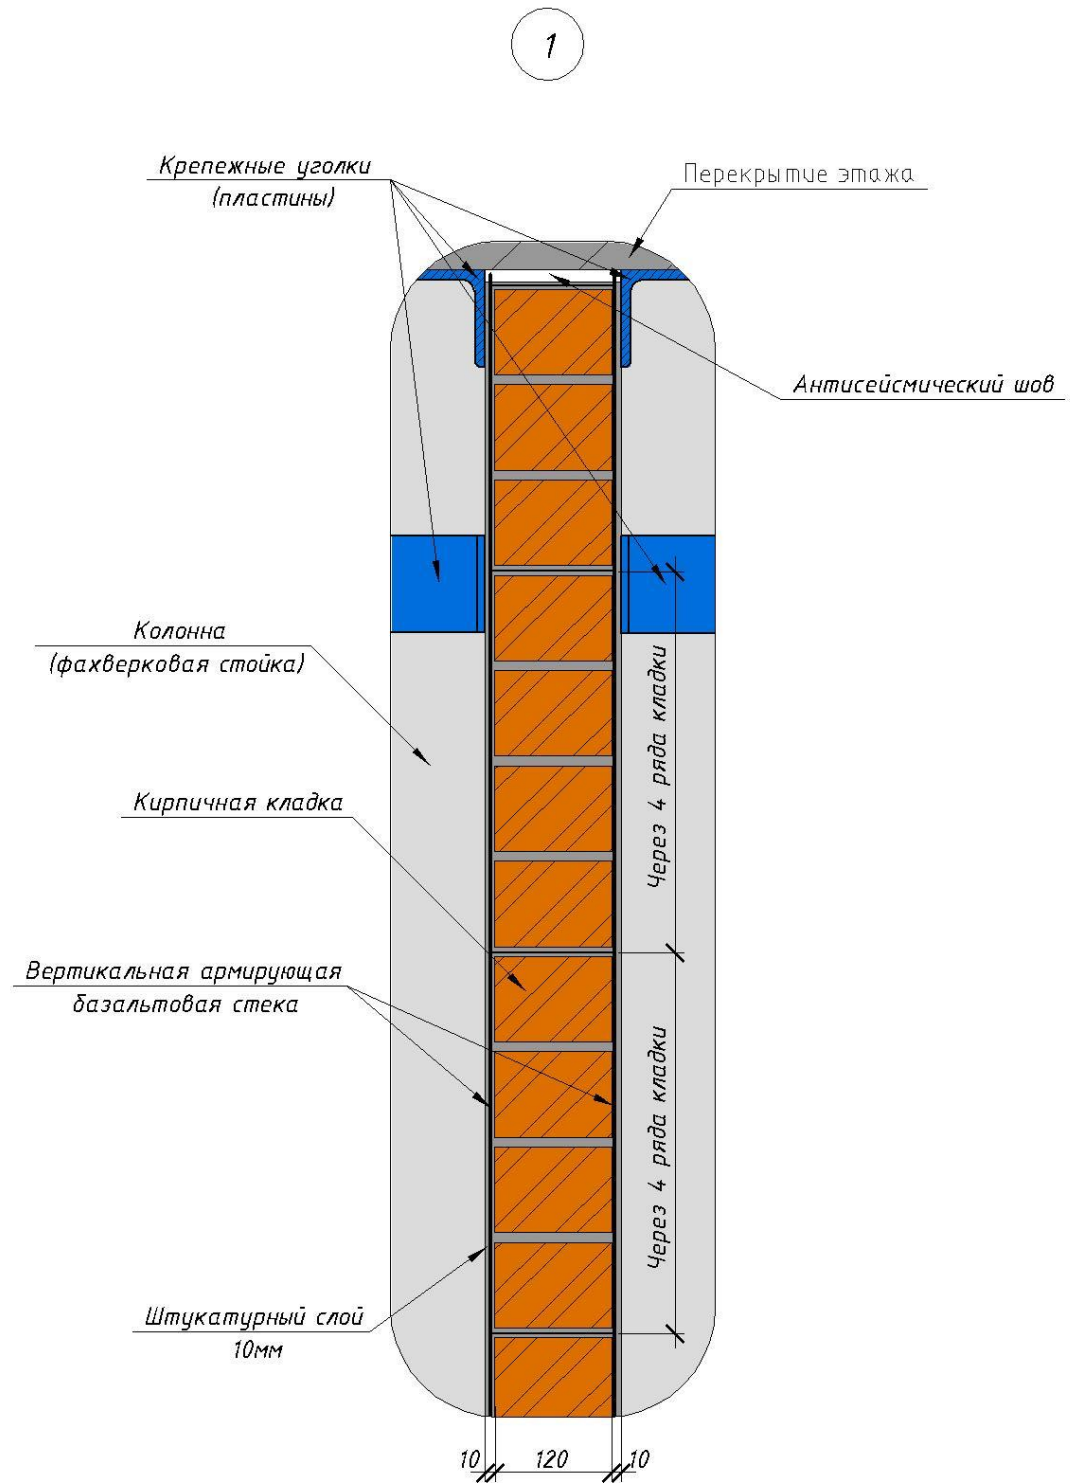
Схема крепления перегородки из кирпича, усиленной вертикальным армированием с помощью базальтовой сетки, к каркасу здания. Узел 1
